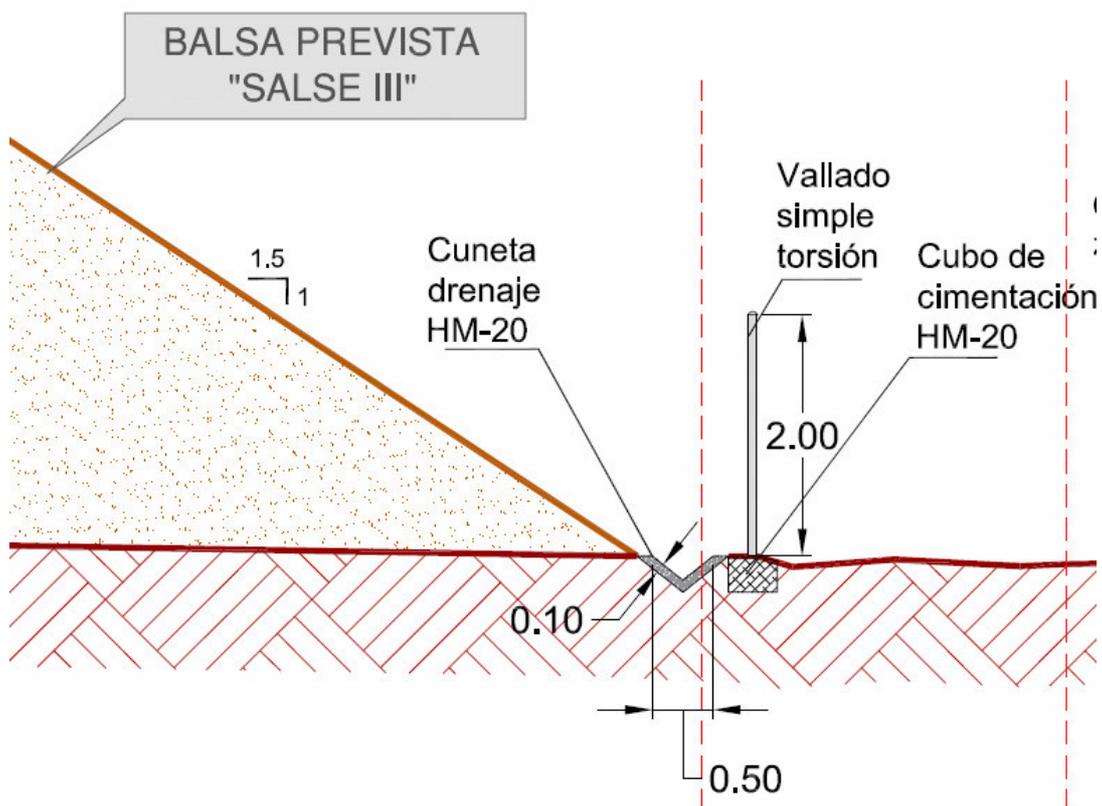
Detalle del vallado perimetral y de la cuneta pie de terraplén. Fuente: Elaboración propia
